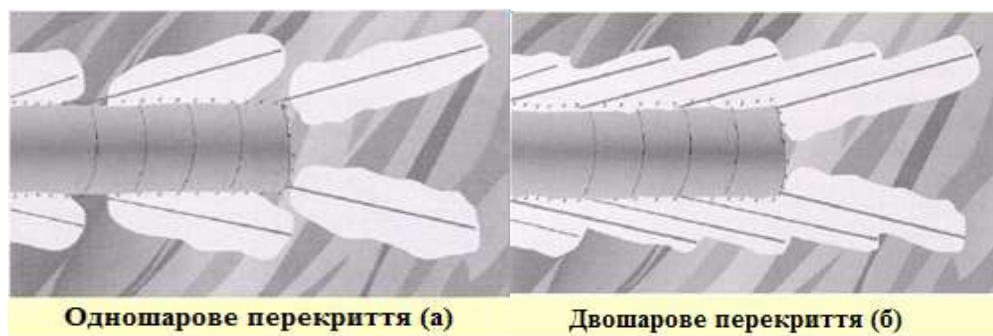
Одношарове перекриття (а) та двошарове перекриття (б)
